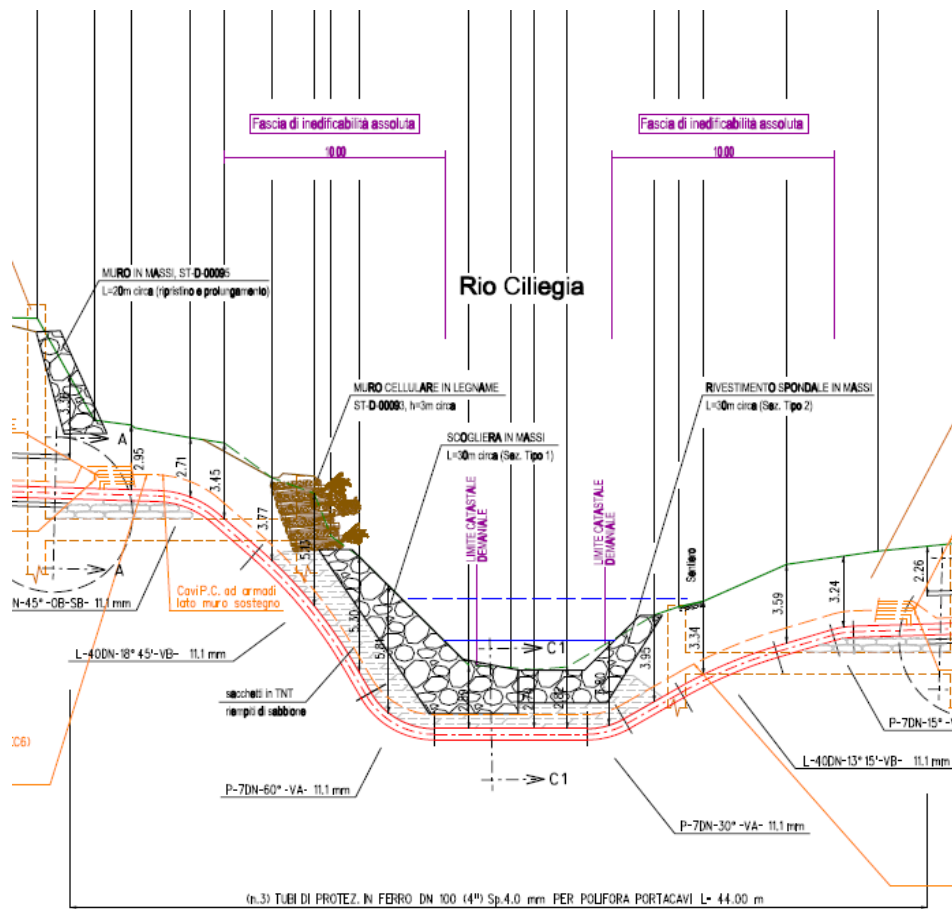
Sezione del Rio Ciliegia secondo il progetto originale
